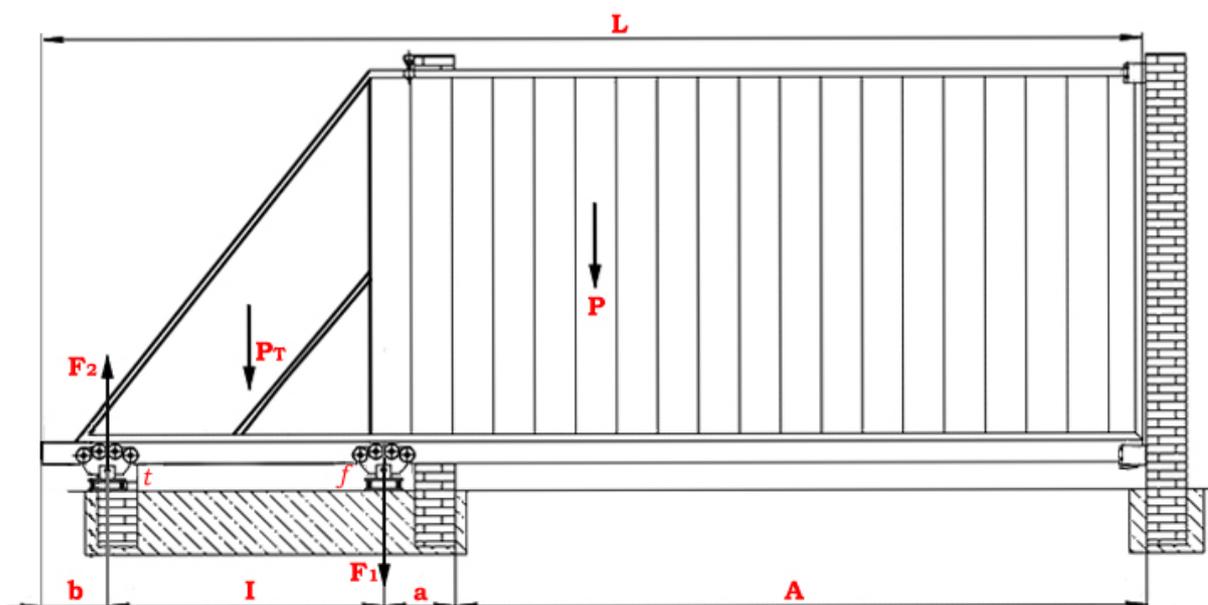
Схема сил, действующих на элементы конструкции ворот, кроме ветровых.
